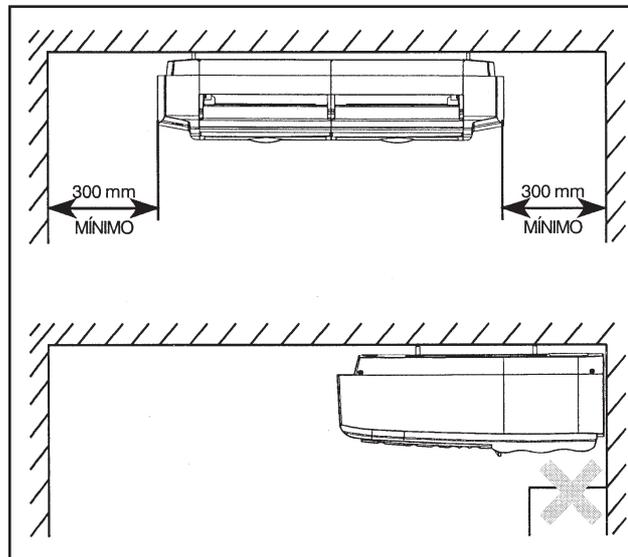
MONTAGEM TETO - UNDER CEILING
